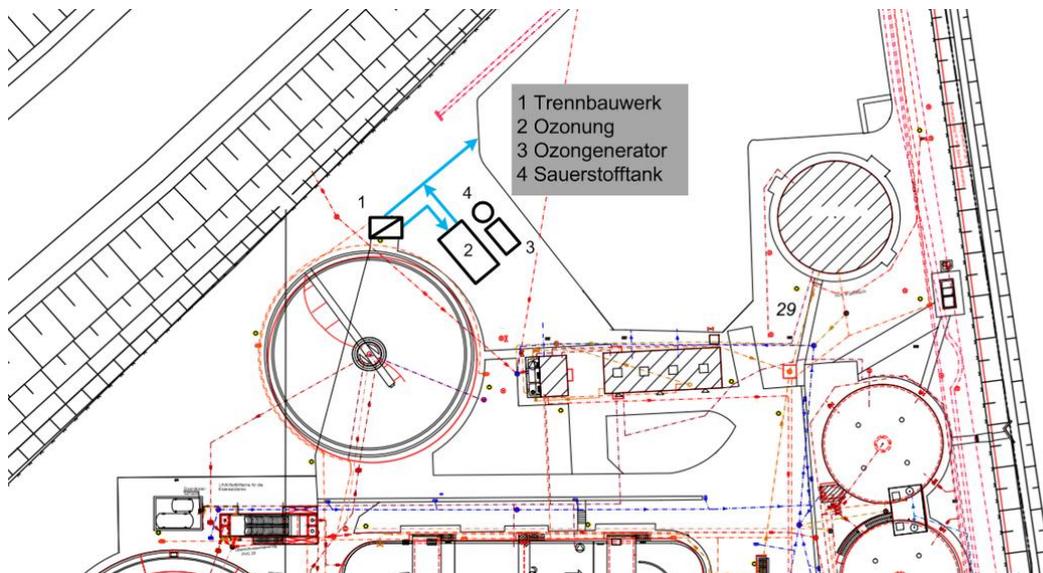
Lageplan der Ozonung auf der Münster-Geist
